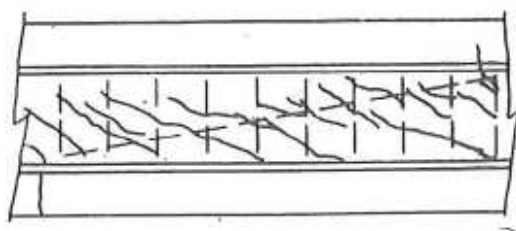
c. Fisuración en el alma de vigas continuas en doble "T" pretensadas con armadura transversal (Sozen)
